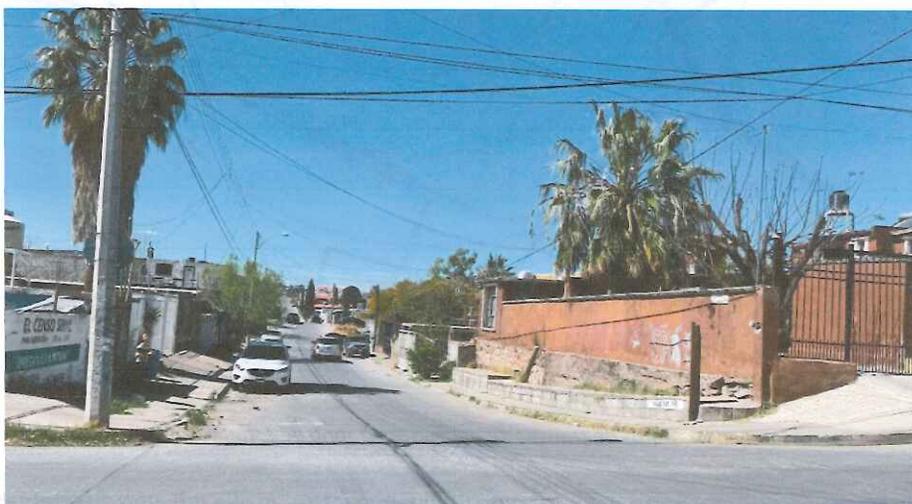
Calle 100 1/2, sección de calle: 12.00 metros
